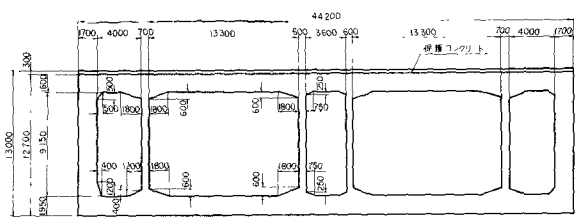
東京湾横断道路沈埋トンネル横断面 構造一般図(計画案)
